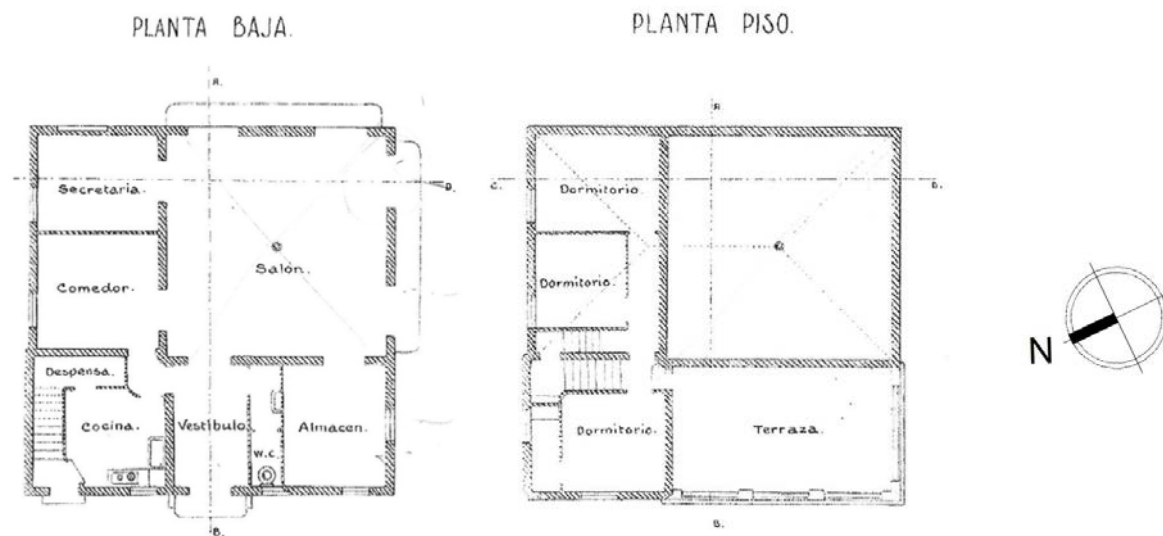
Plantas del proyecto de Carles Garau, 1927.
